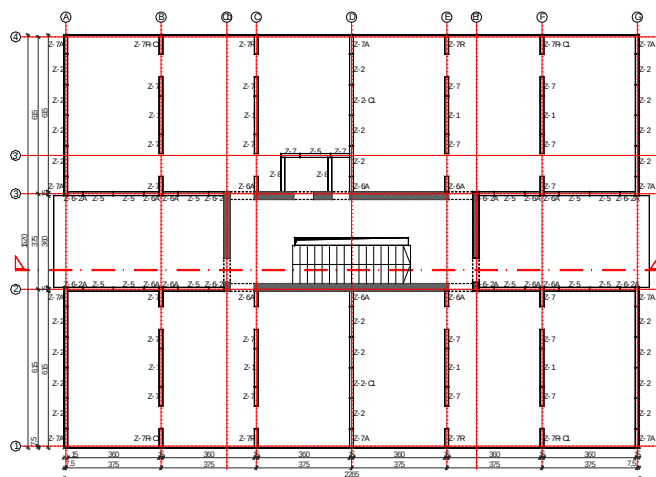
Planimetria e katit karakteristik të ndërtesës S5, mure me panele BA
